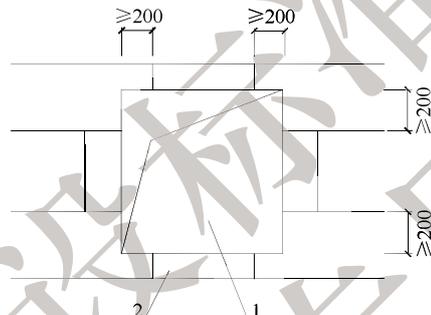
门窗洞口保温板排板示意（尺寸单位：mm）
